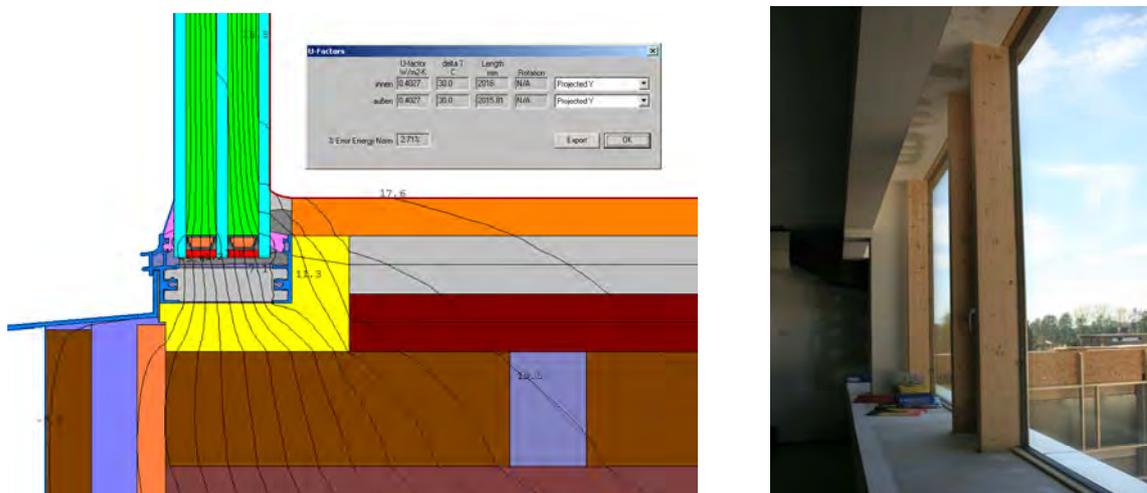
Einbau Fixverglasung mit verbessertem Einbau
